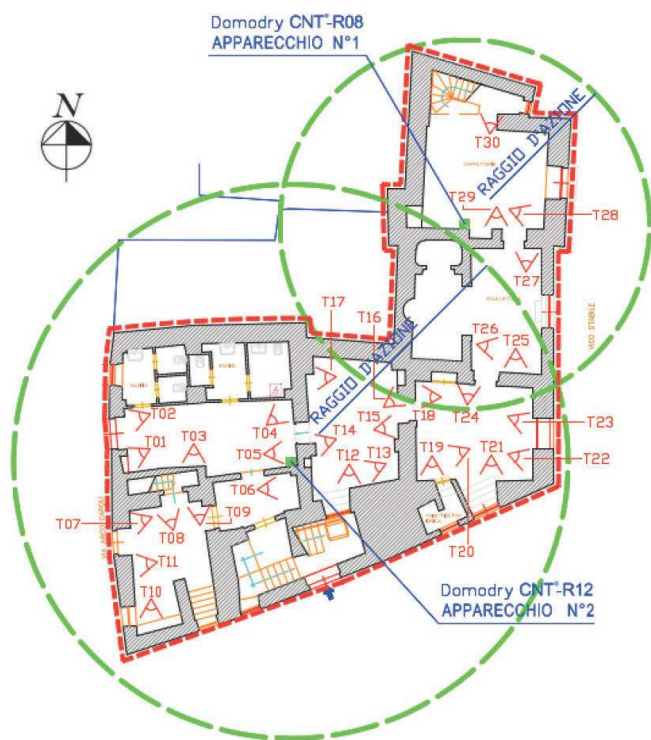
Palazzo Stabile, sede del MuBa: schema planimetrico impianto CNT
